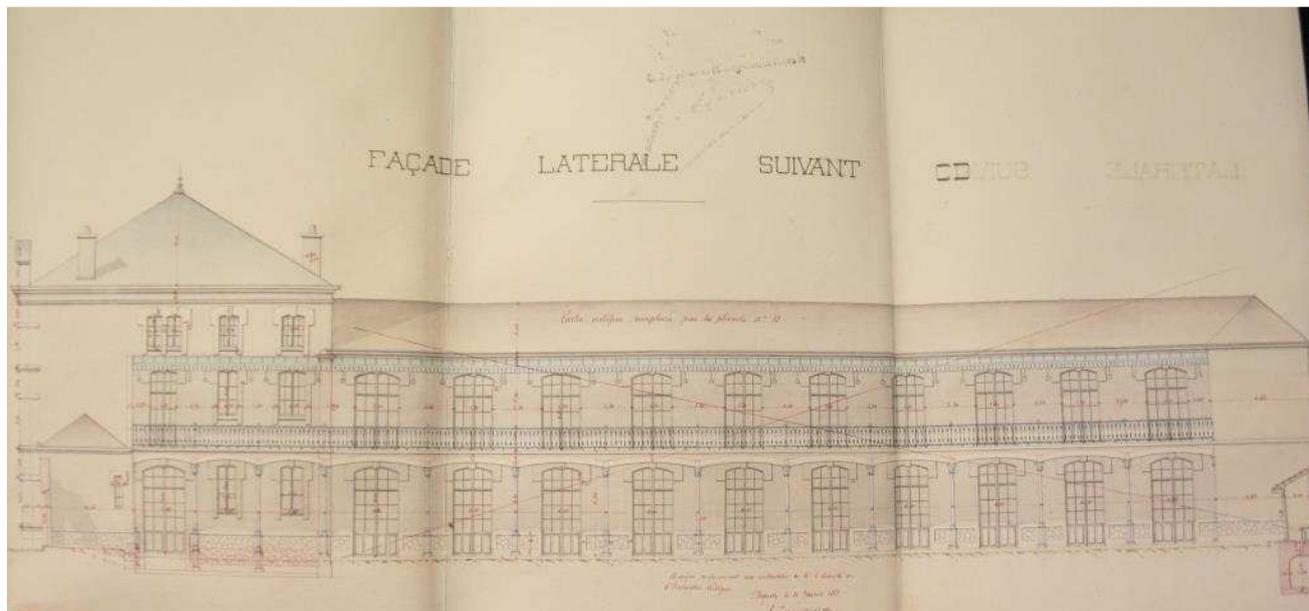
Projet de Groupe scolaire. Façade latérale suivant CD.
